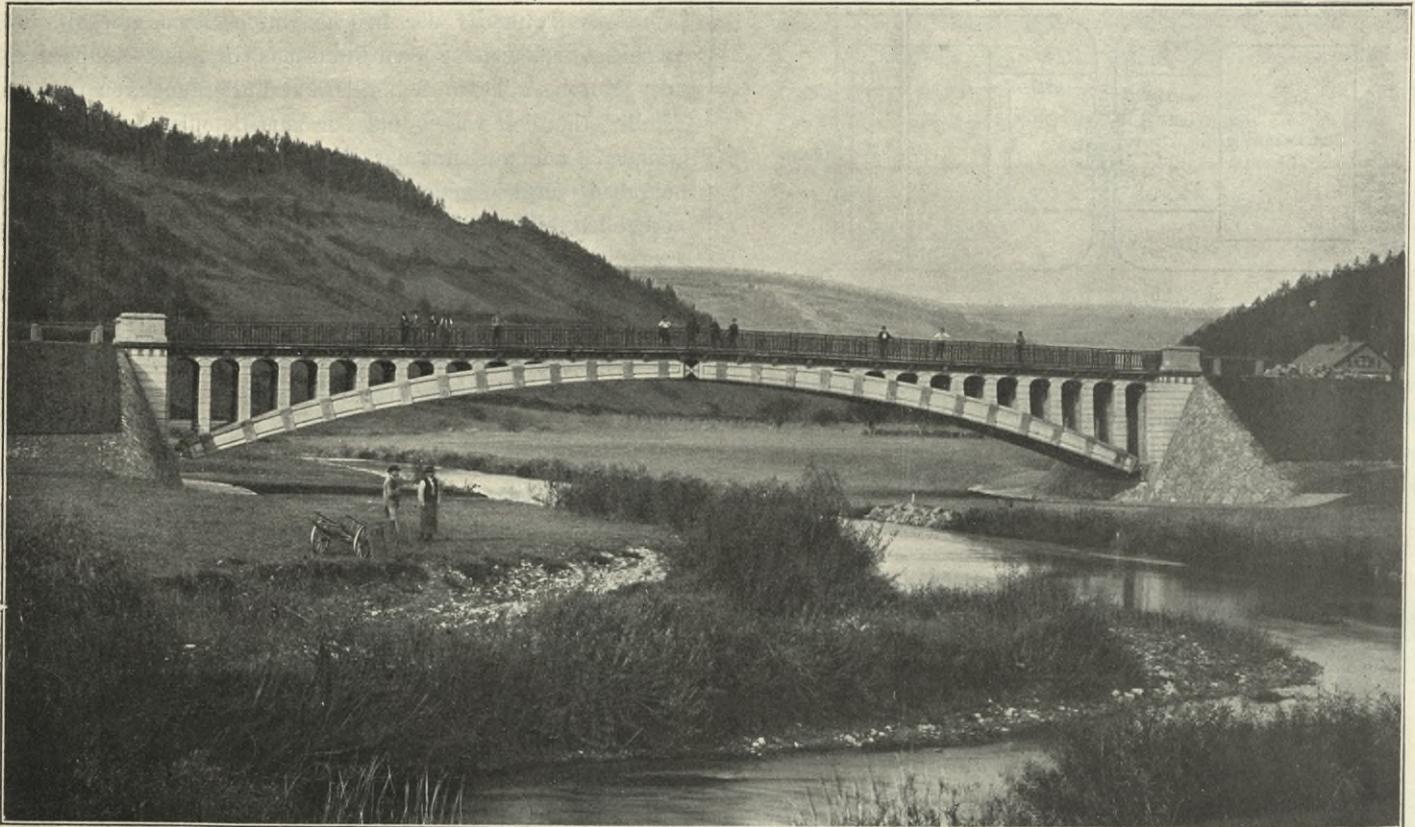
Ansicht der Brücke bei Neckarhausen.
